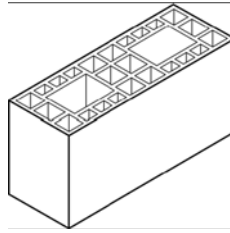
Bloco cerâmico estrutural de paredes vazadas.
